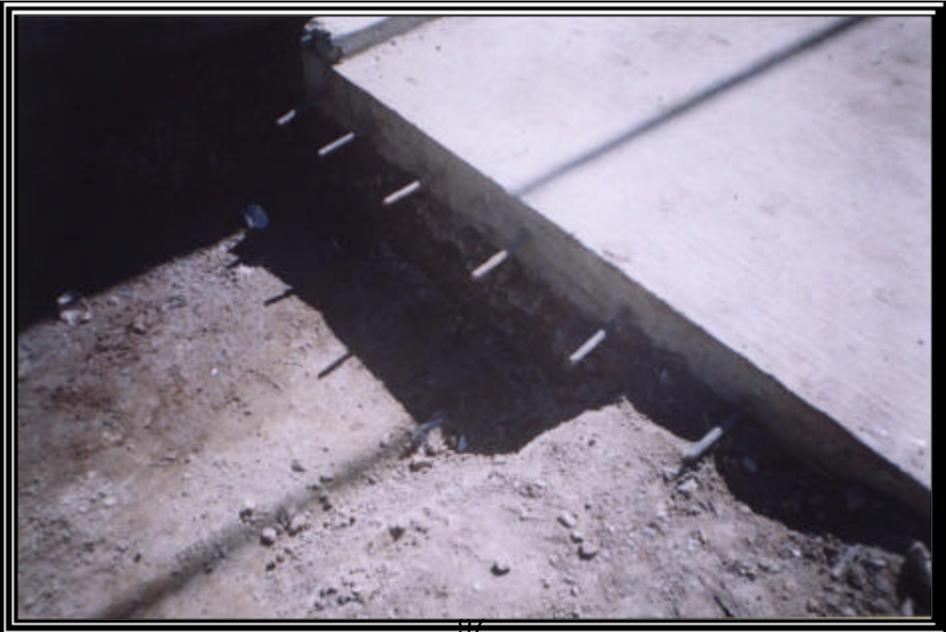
CORTE DE PAVIMENTO EXISTENTE
